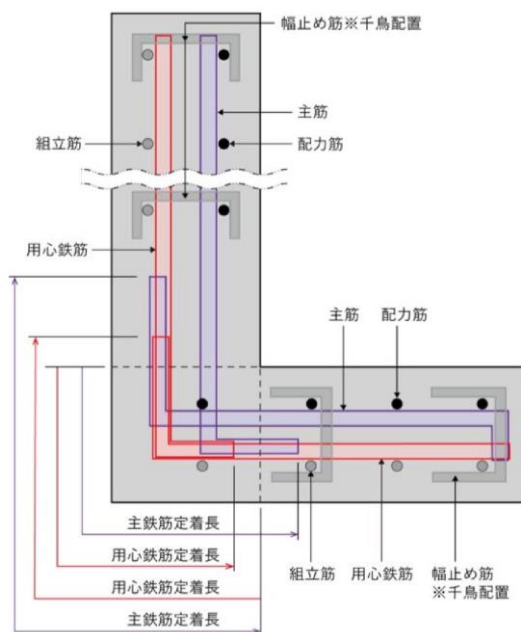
L型鉄筋コンクリート擁壁縦壁基礎部の配筋要領
